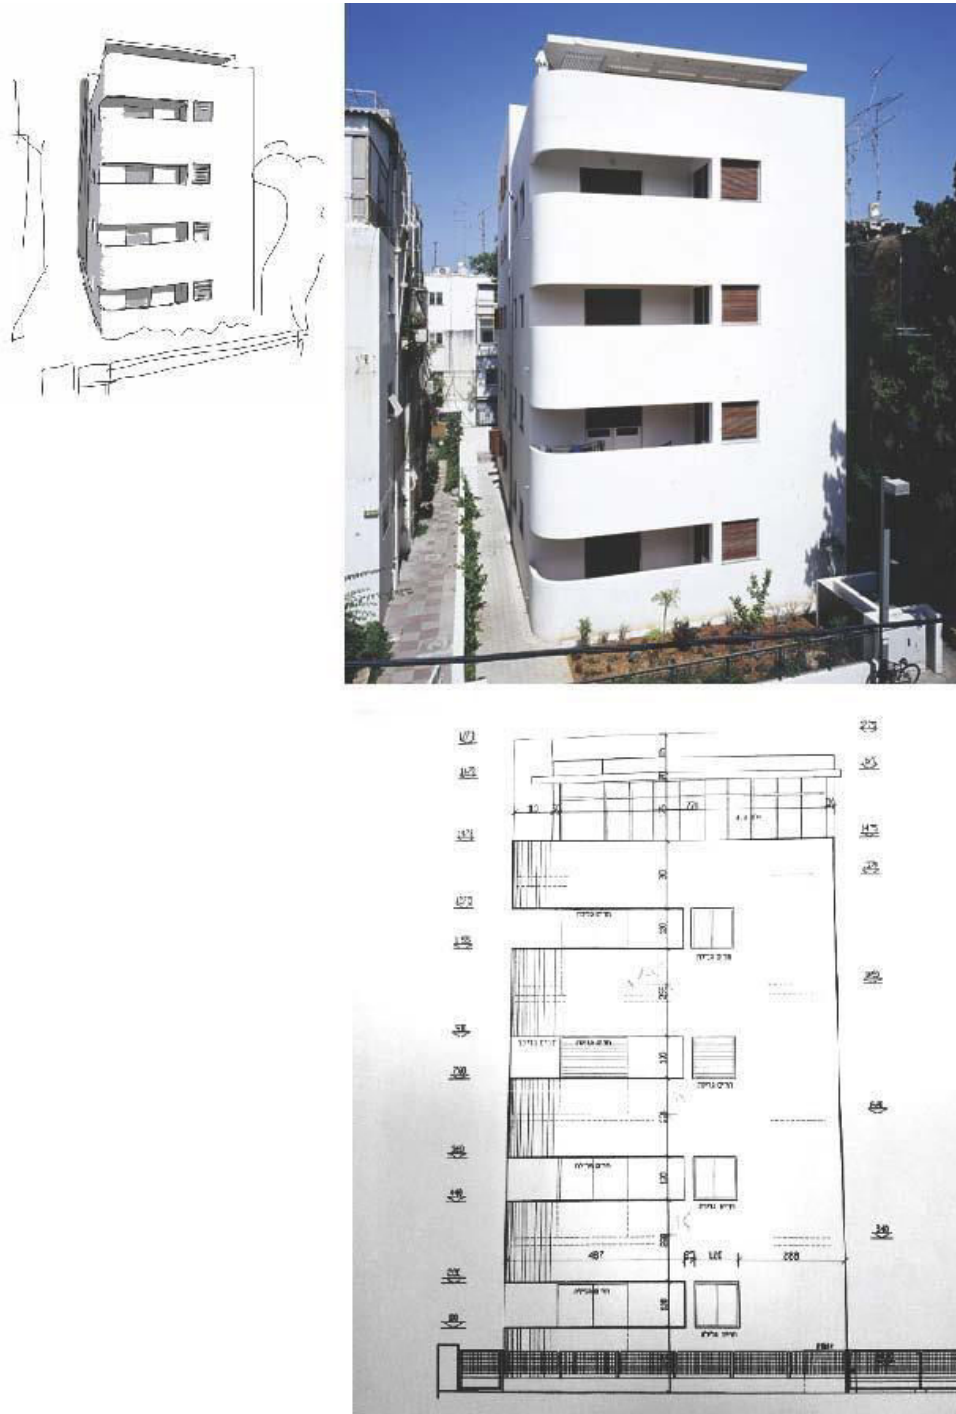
Surélévation d'un 'étage en contour' au 7 rue Feierberg. Illustration et photo de façade este par Jeremie Hoffmann. Détail de Façade este ADCTJ
